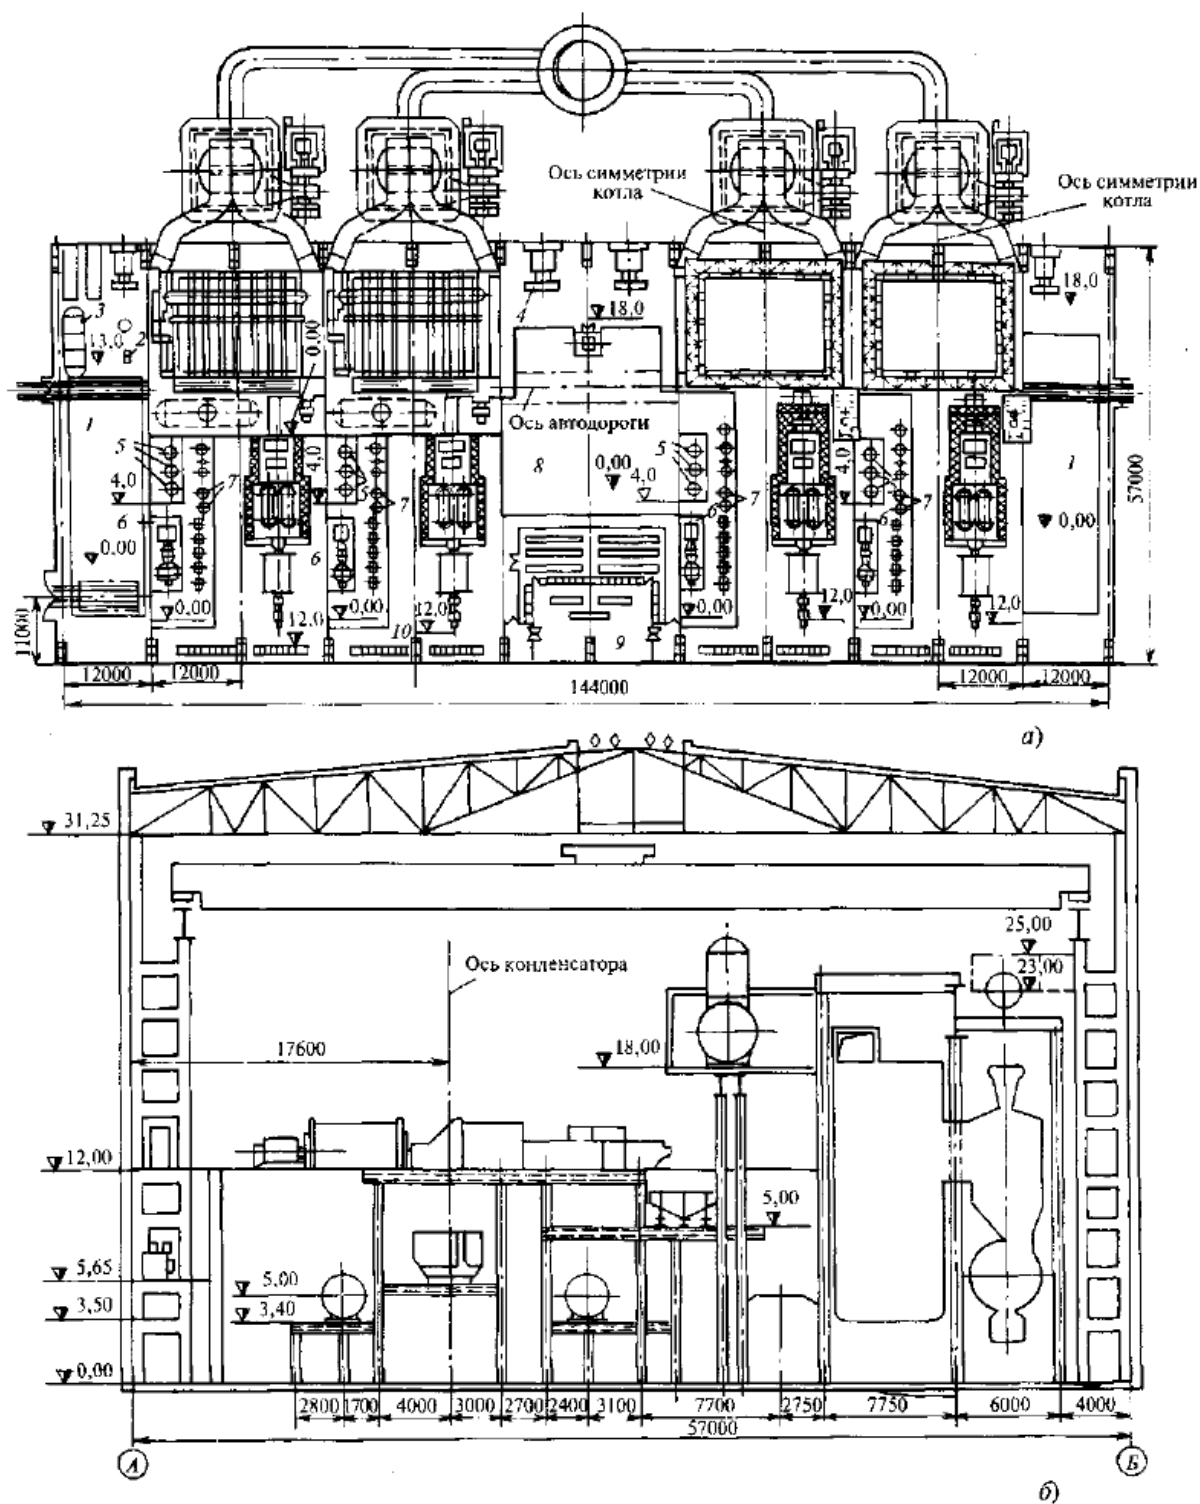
Компонировка главного корпуса серийной газомазутной ТЭЦ-ЗИГМ с малогабаритными котлами:
